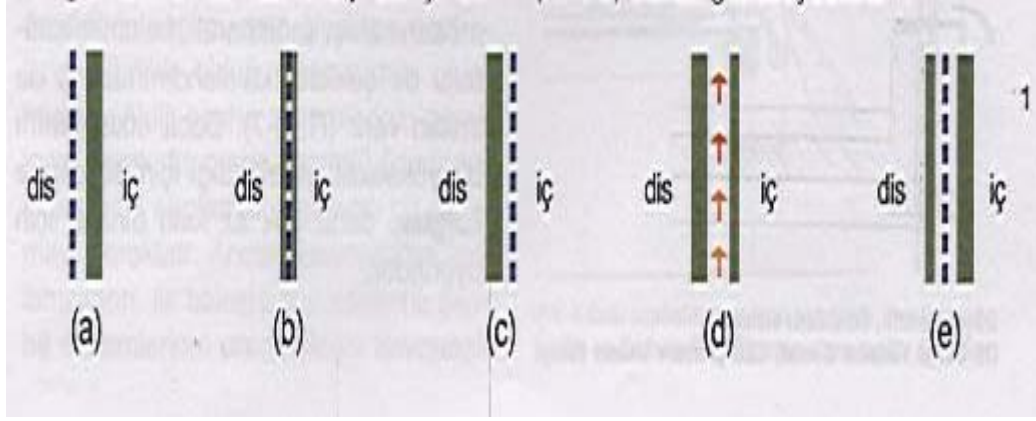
Opak ve Saydam Panellerin Kullanım Detayı
